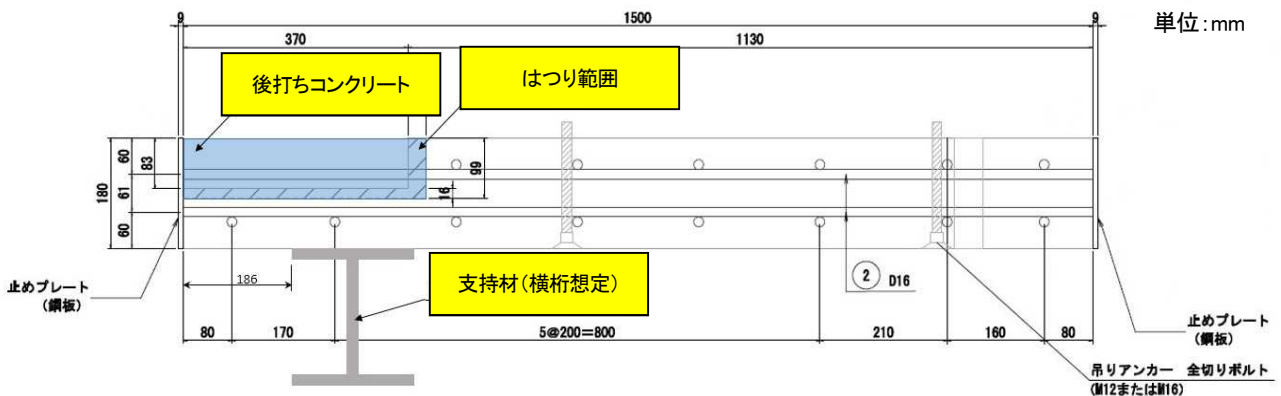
後打ちコンクリートに関する輪荷重走行試験 試験体概要
